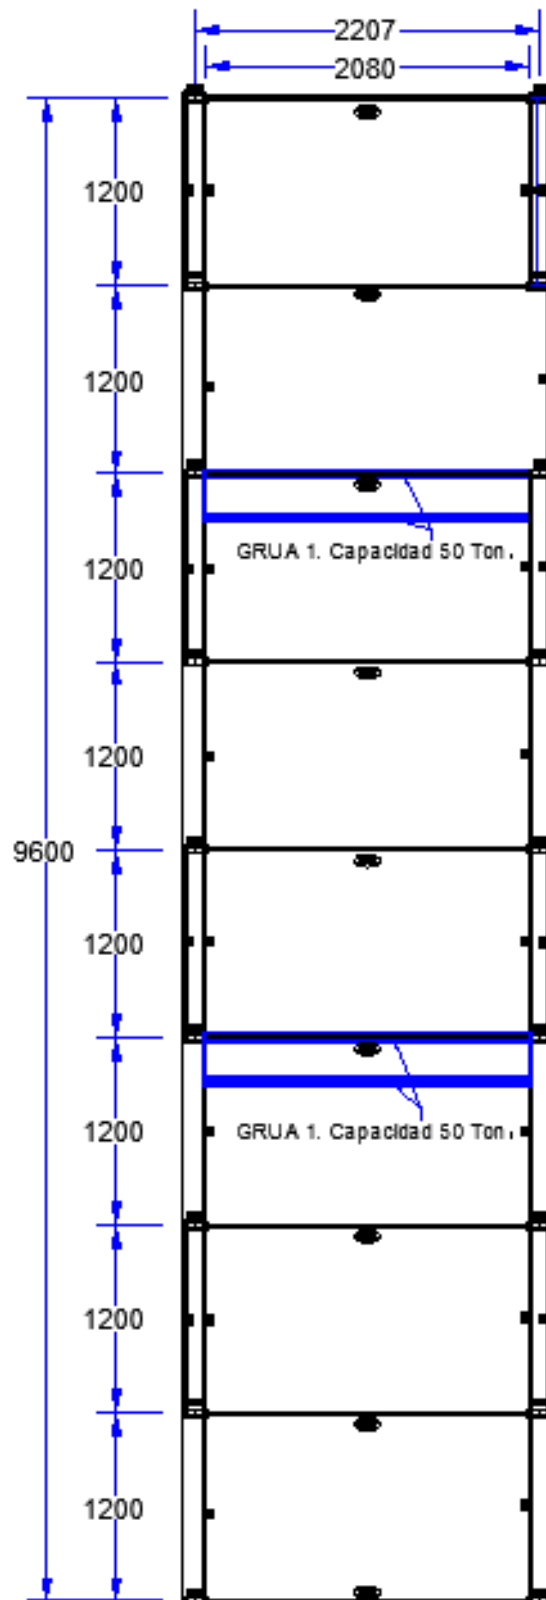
Dimensiones en planta de la estructura de soporte.
